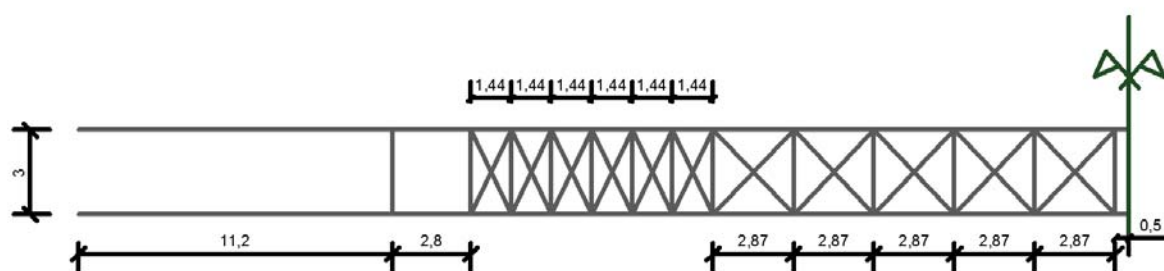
Malha de contraventamento inferior na metade esquerda (vista em planta)
